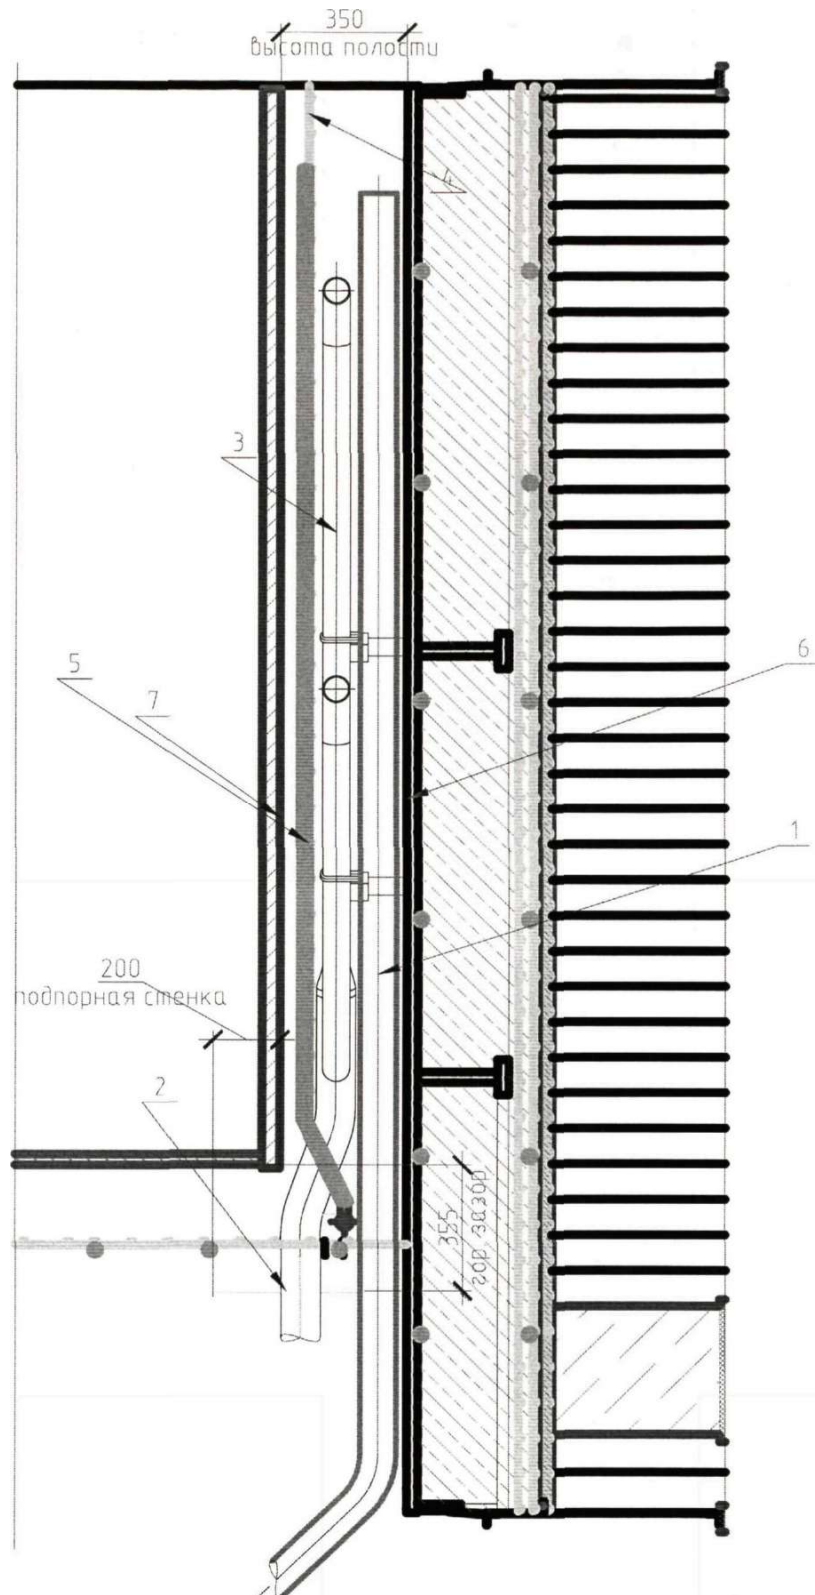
Схема порожнини (розріз): 1 - бетоновод; 2 - кільцева знімна опалубка; 3 - трубопроводи; 4 арматурна сітка; 5 - гнучкі гофр.трубки; 6 - нижня металева плита; 7- верхня металева плита
